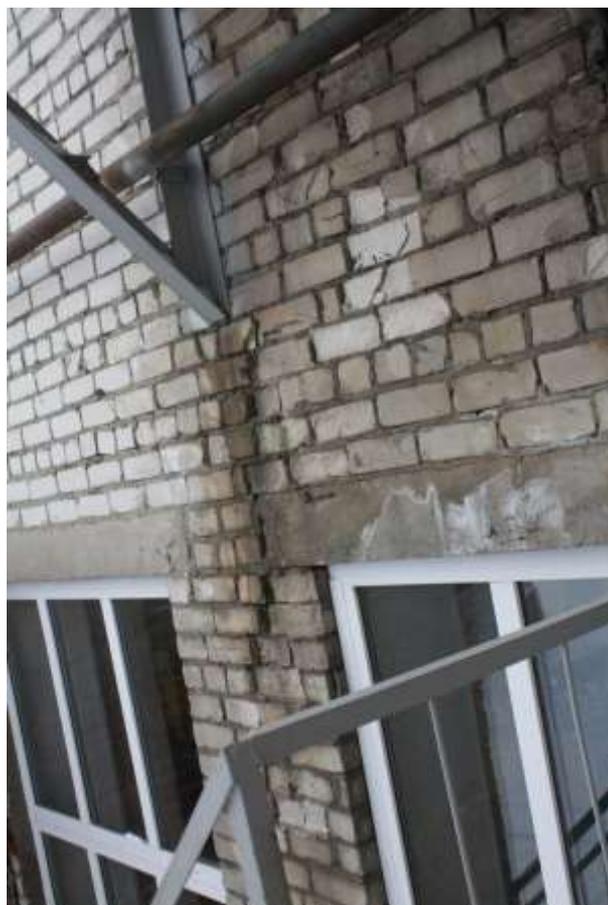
Разрушение кирпичной кладки «лещадкой» с наружной стороны стены в осях «Б/6-7» с отметки+2.700м до отметки +7.100м.
